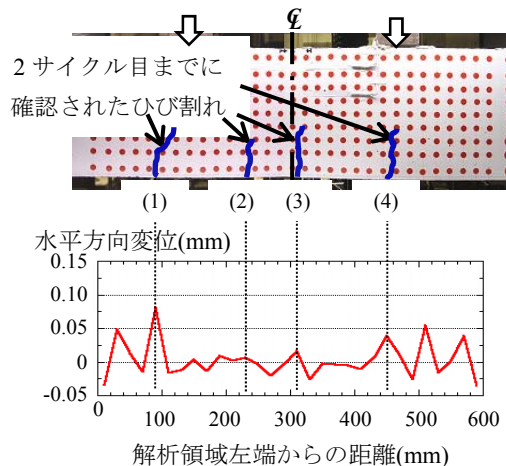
ひび割れ位置および下縁部の水平方向変位 (R-10)
